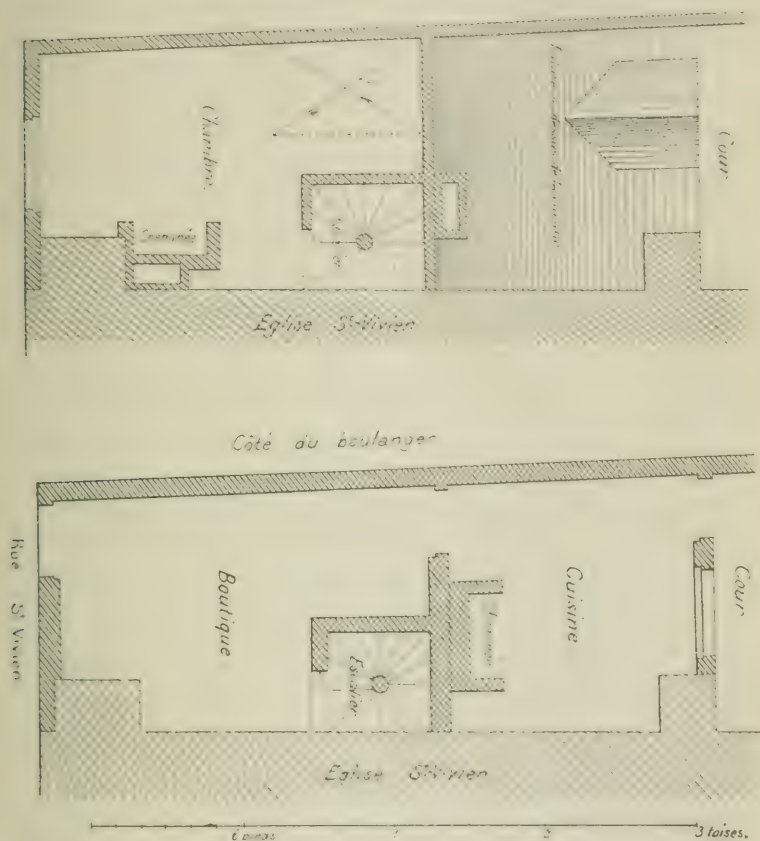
, 19. — Rez-de-chaussée et premier étage d'une maison rouennaise, 1670; d'après A. S. I.: G. 7818.
